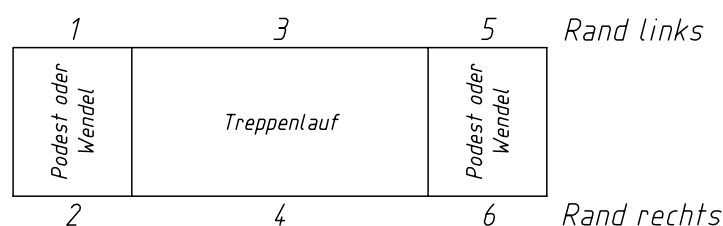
Auflagerzuordnung für quergespannte Treppenkonstruktionen
